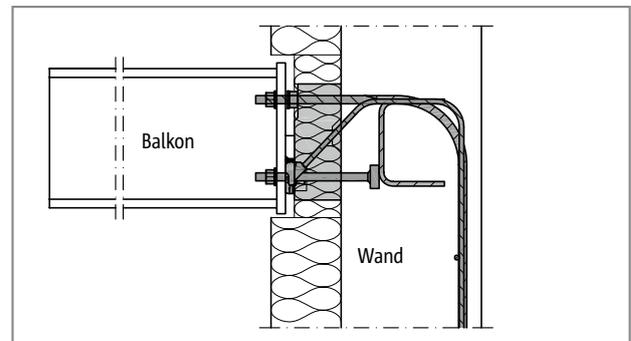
Schöck Isokorb® T Typ SK-WU-M1: Sonderkonstruktion für Wandanschluss auf Basis der Haupttragstufe M1 für Wandstärken ab 200 mm
